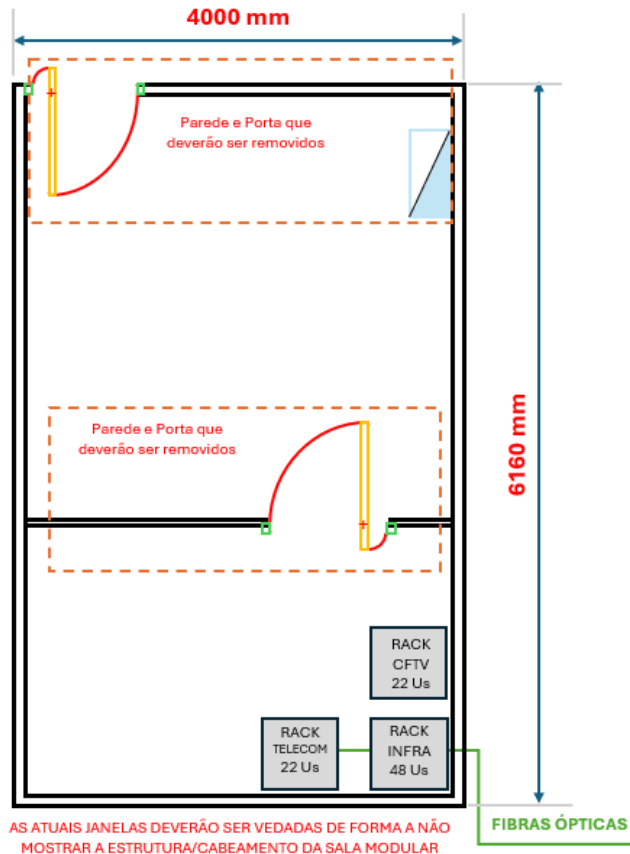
Planta Baixa – Ambiente atual – dimensões estimadas
